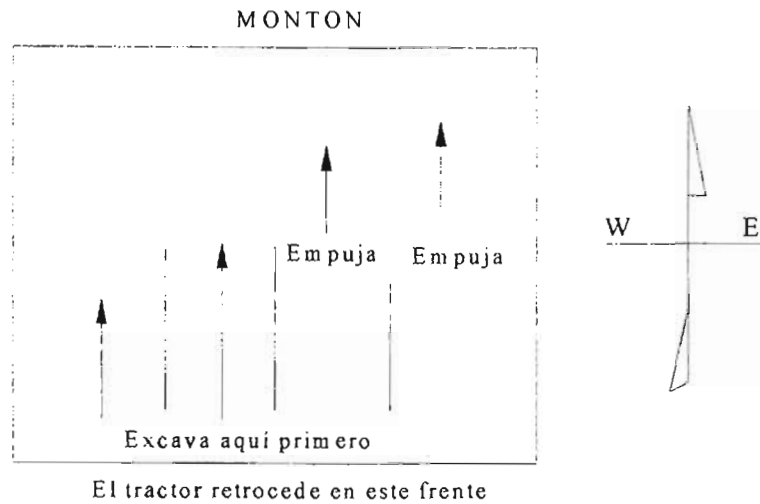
Secuencia de la Excavación con Bulldozer (Planta).
